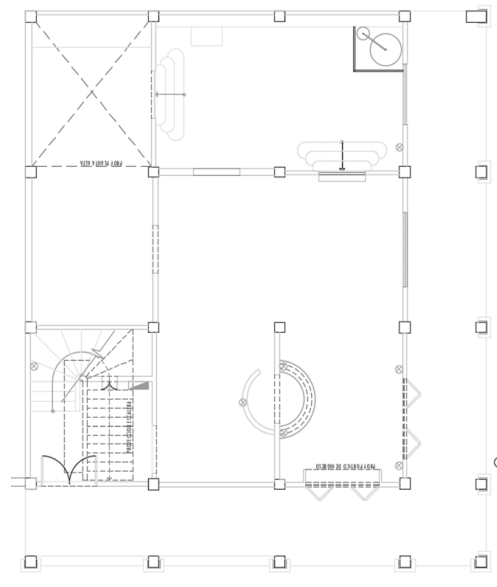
Plano arquitectónico de la planta alta de la Casa de los Estancos. (INPC, 2017)
